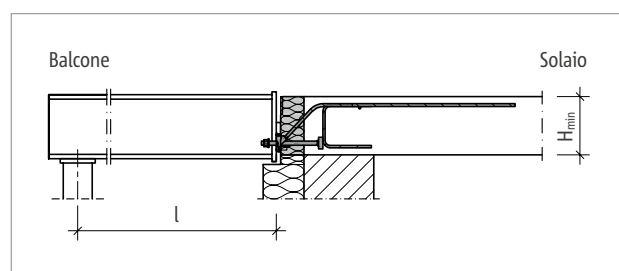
Schöck Isokorb® T tipo SQP: schema statico
